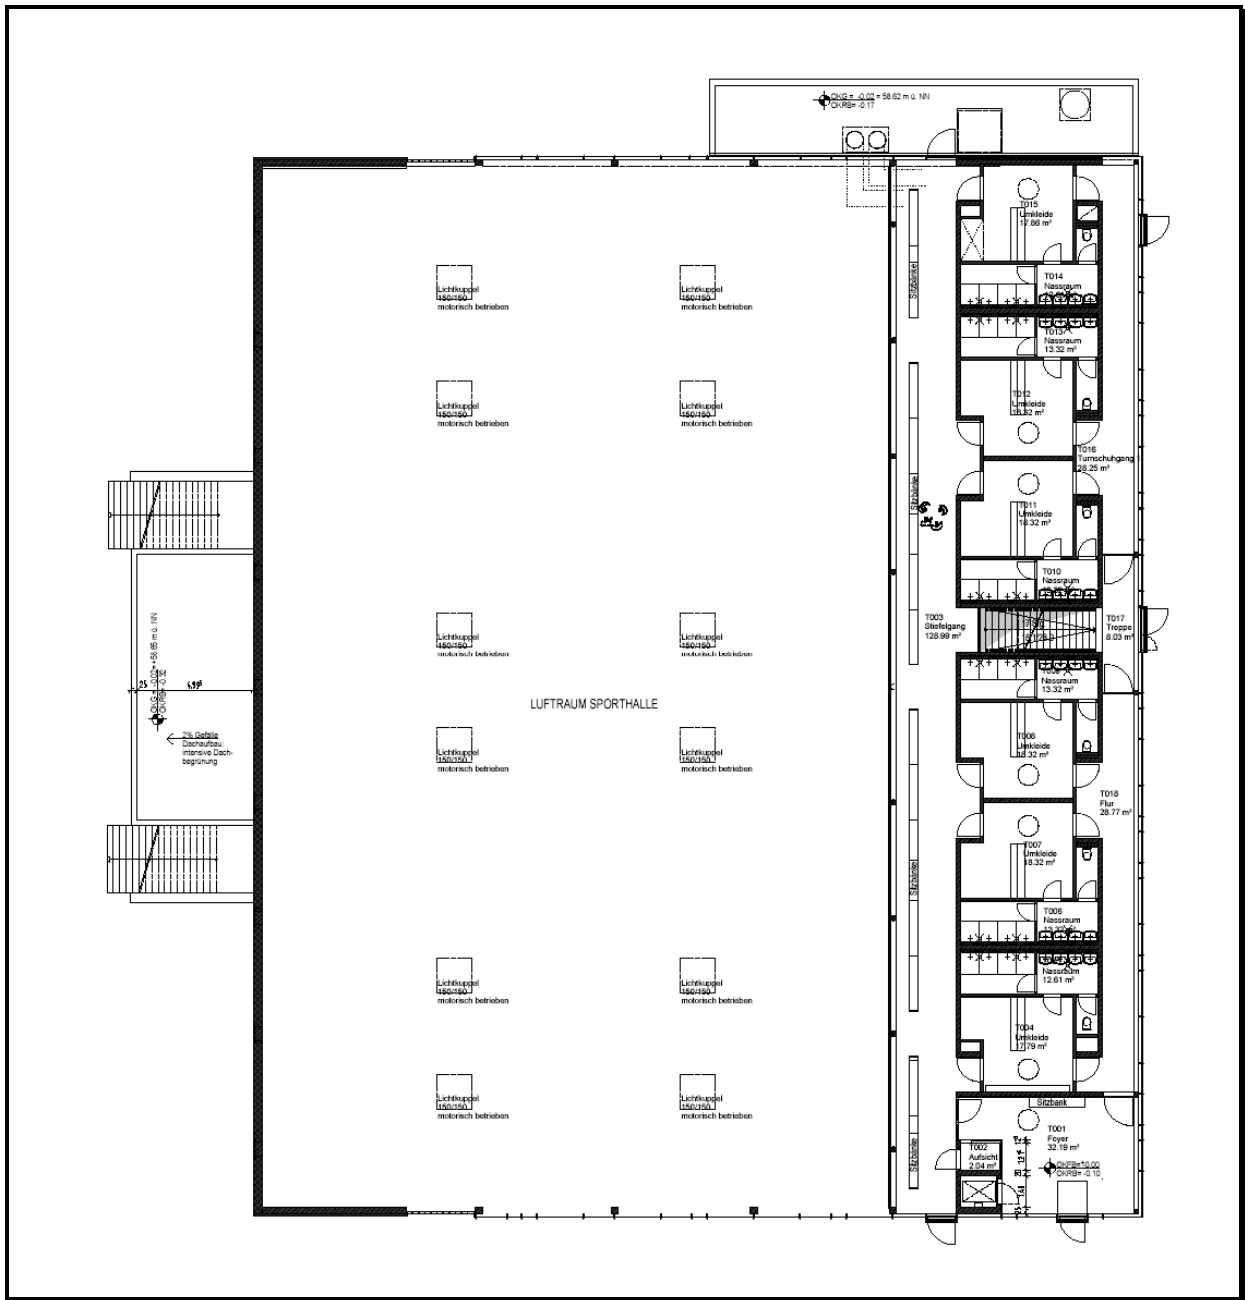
Friedrich-Ebert-Realschule: Grundriss Erdgeschoss Sporthalle
